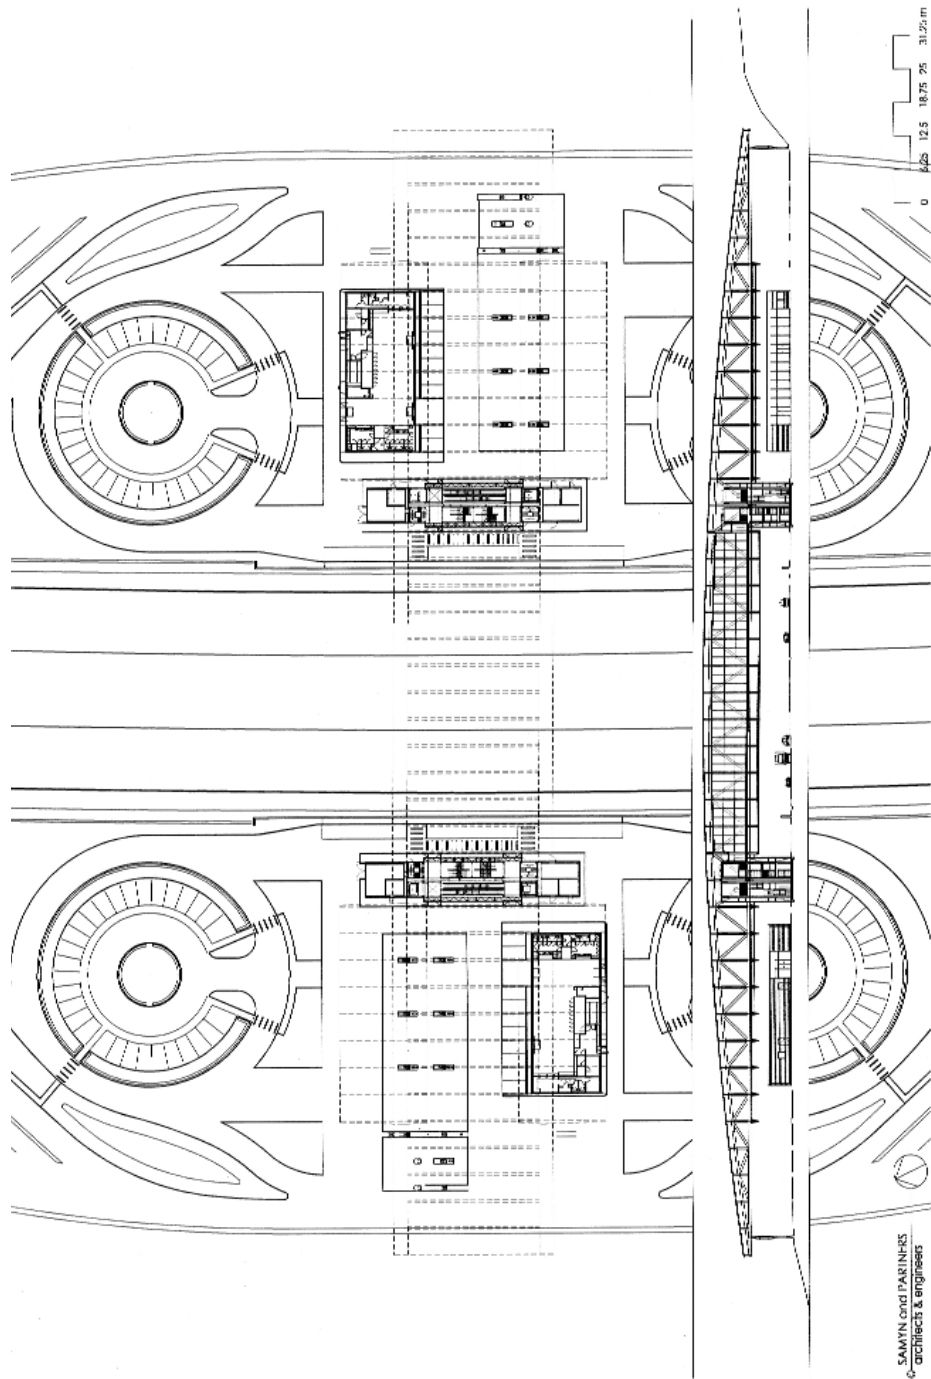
Progetto definitivo - Pianta delle stazioni e prospetto longitudinale (Samyn & partners)
